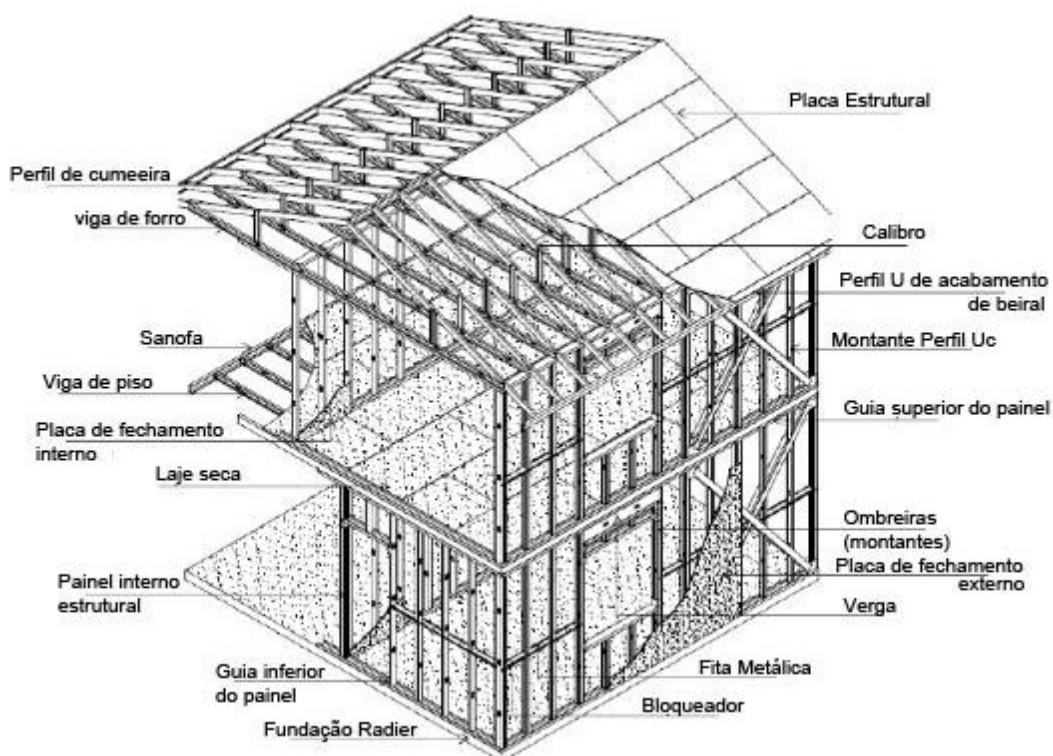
Estrutura do sistema construtivo *light steel frame
